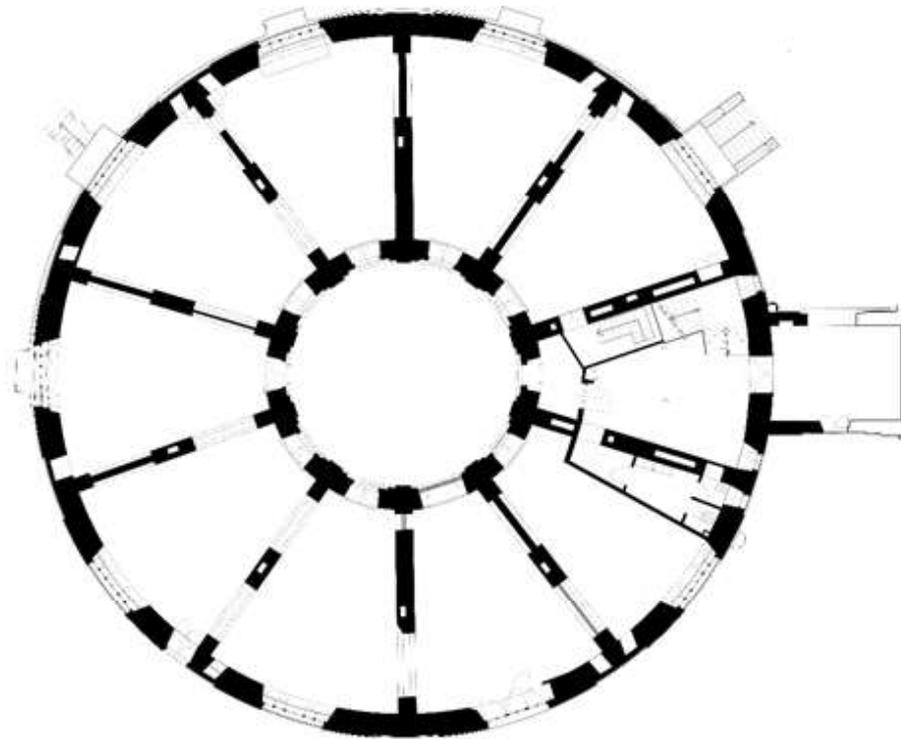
pianta piano terrea, stato di fatto, Rotonda
